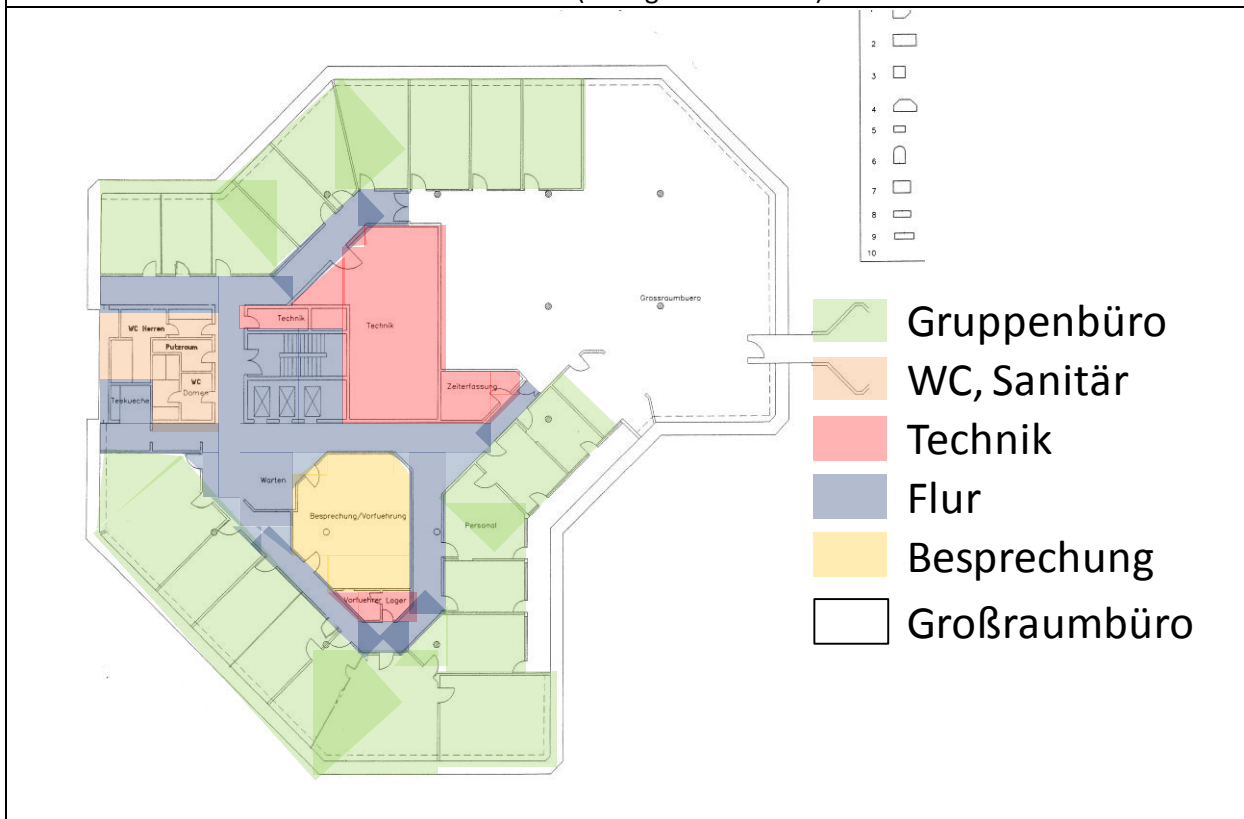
Grundriss-Zeichnungen des BA I mit Zonierung¹³⁰
